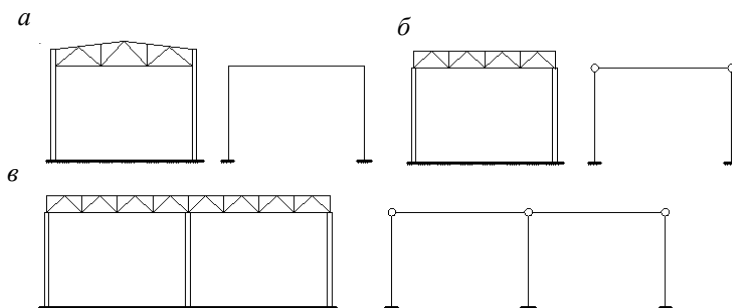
Виды сопряжений ригеля с колонной производственных зданий:
